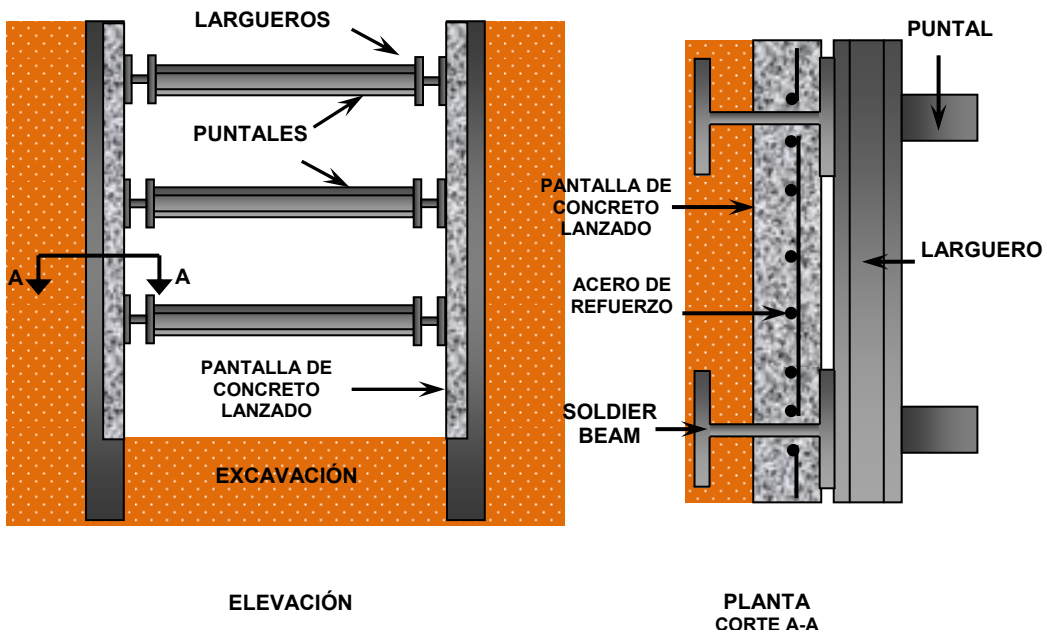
Revestimiento de concreto lanzado y colocado entre soldier beams.
